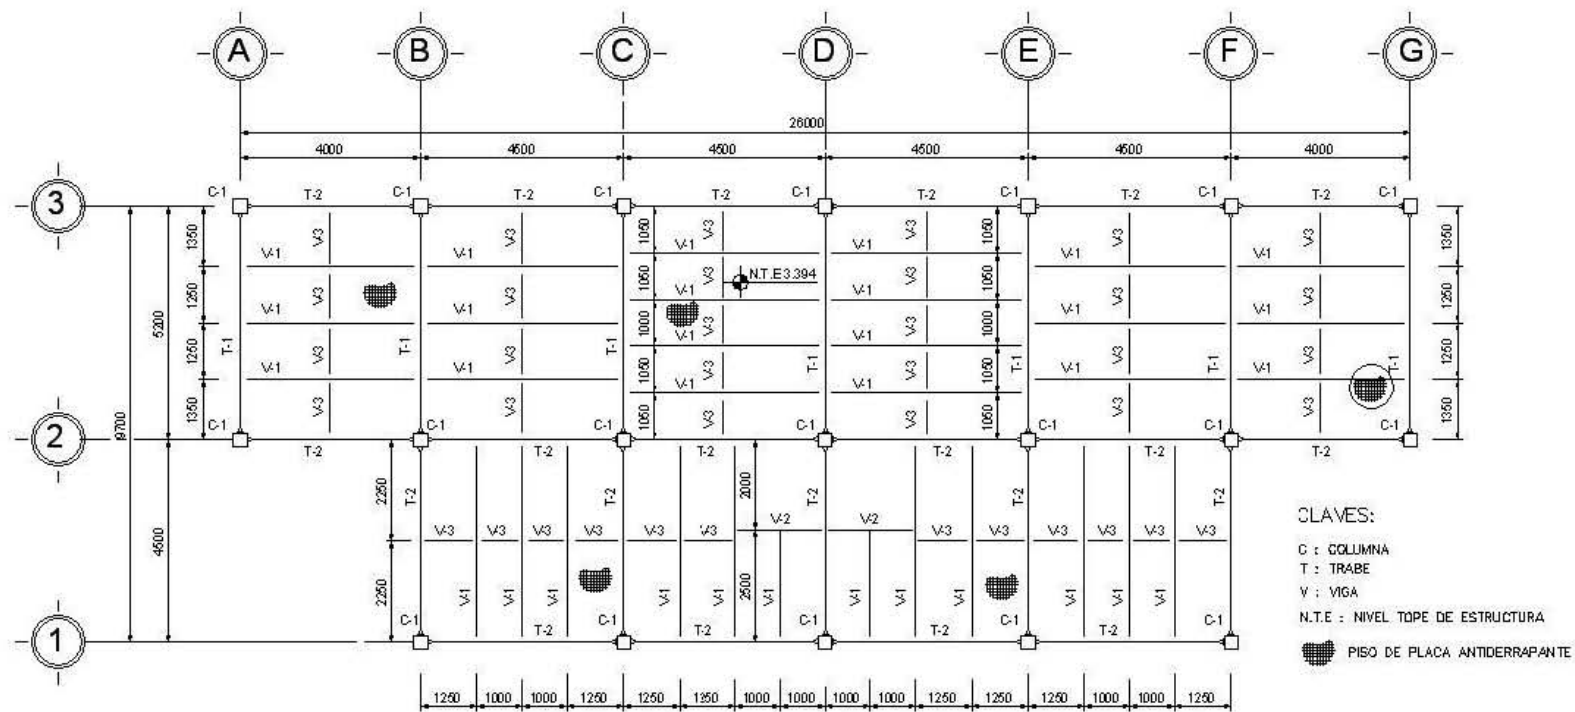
Planta estructuración de plataforma de producción primer nivel.
